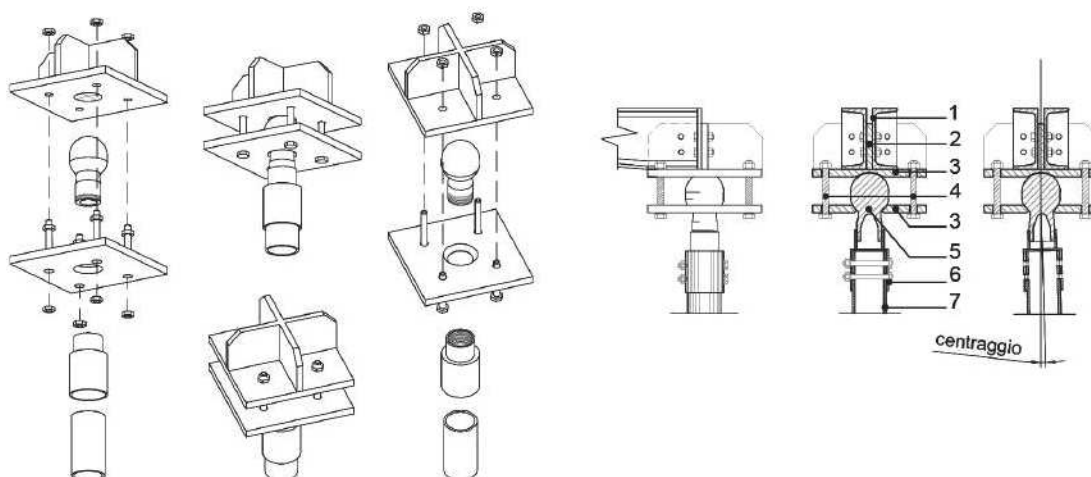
Elemento per assicurare il centraggio verticale della struttura nel caso di fondazioni su pali. Legenda: 1) mensola di collegamento (opzionale); 2) fazzoletto verticale; 3) piastra forata e rifinita al tornio; 4) bulloni di serraggio; 5) giunto sferico; 6) manicotto filettato per la regolazione in altezza con la predisposizione dei fori per il collegamento con il palo; 7) fusto del palo
